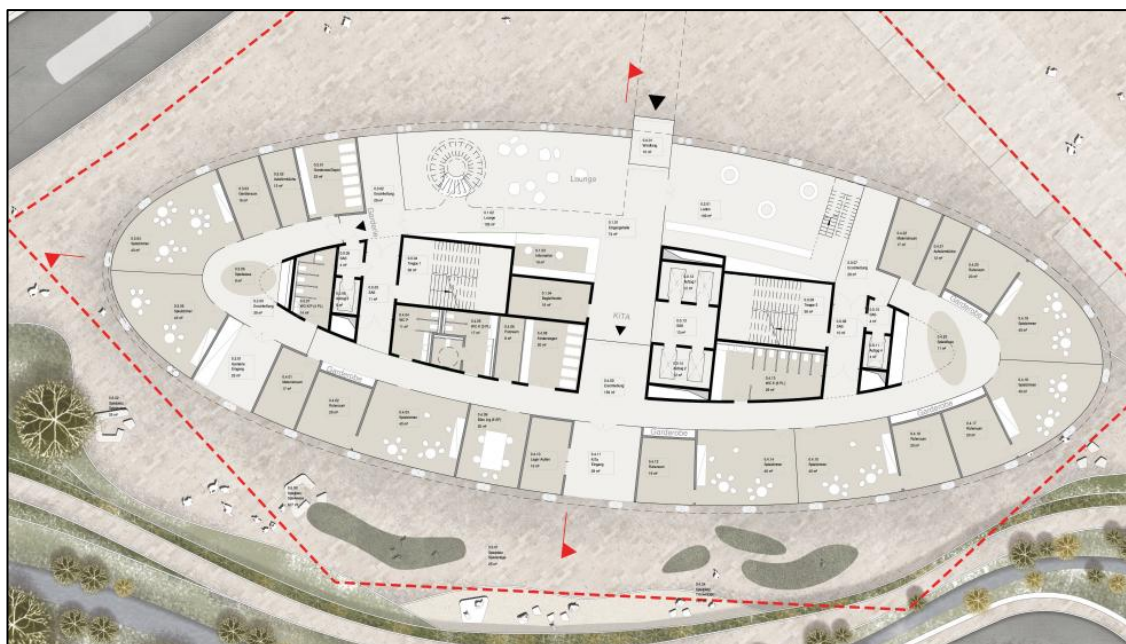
Vue en plan du projet CHEM Ärztehaus
